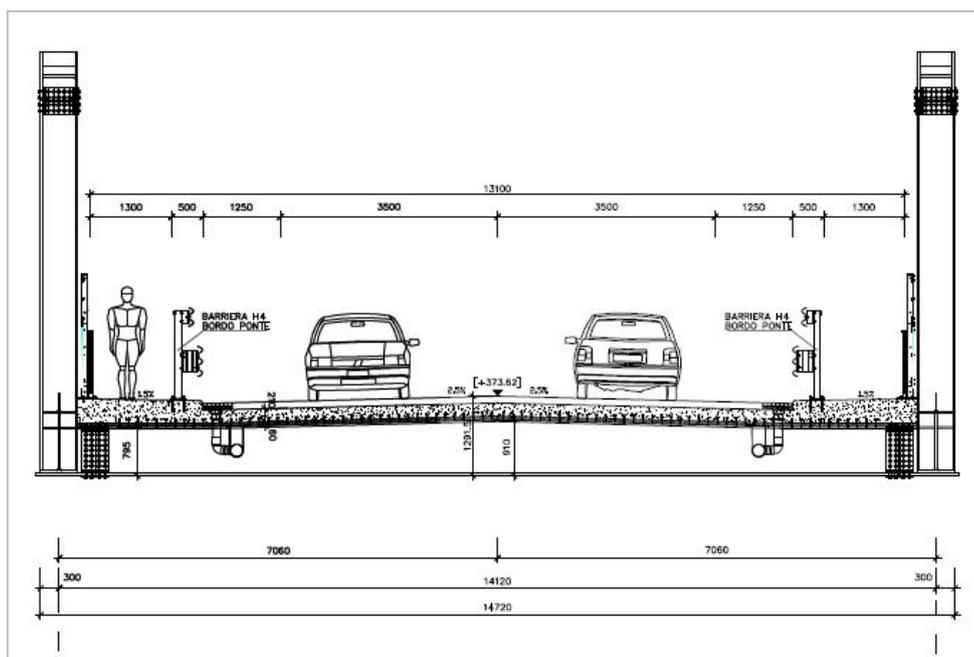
/2 Sezione tipo in corrispondenza del ponte sulla ferrovia
